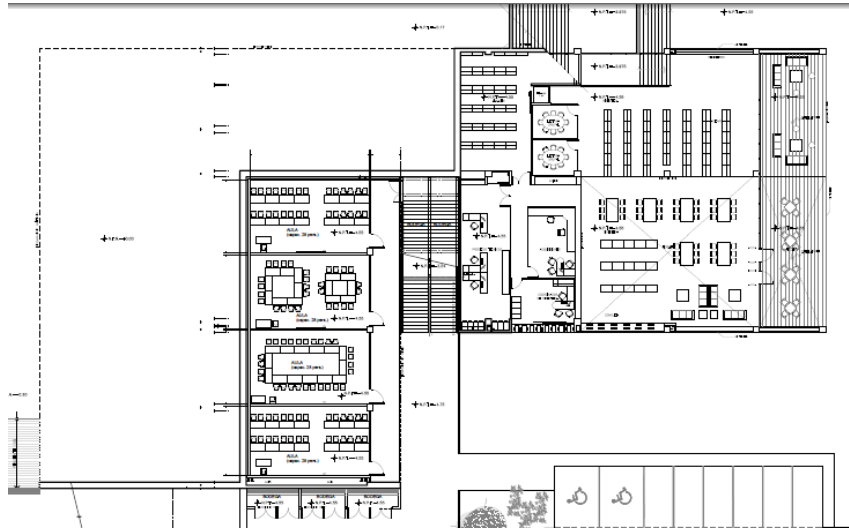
Plano del sótano del CNYN. Recuperada de de planos originales. Planos originales.
